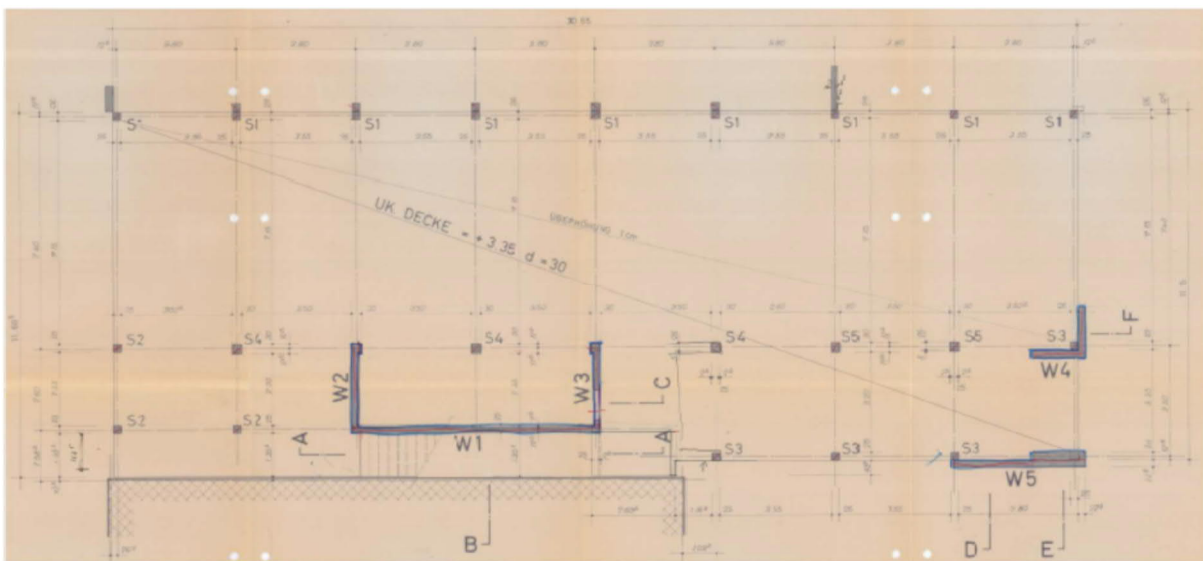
Plan horizontal de la partie 2 du bâtiment, rez-de-chaussée du bâtiment scolaire.
